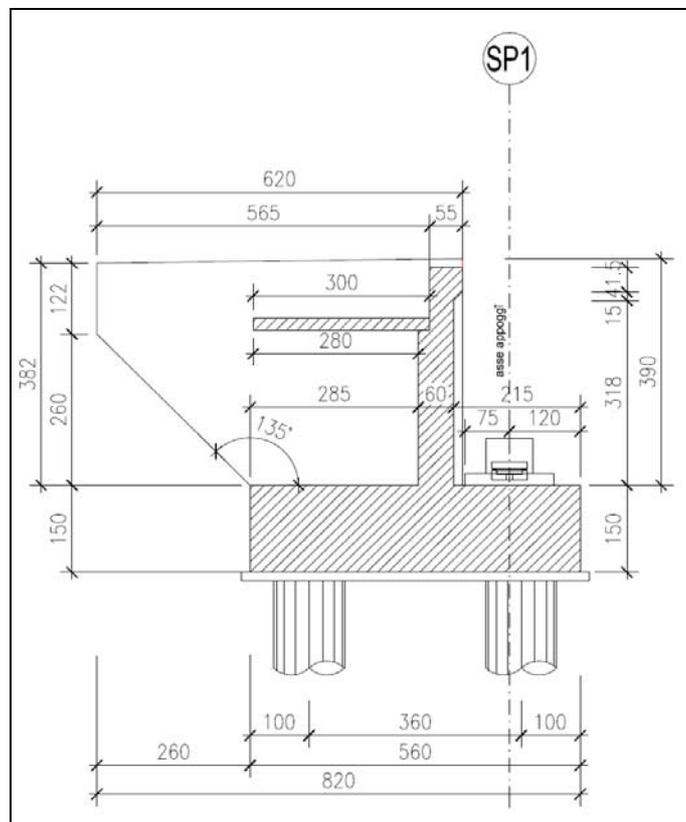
SEZIONE TRASVERSALE SPALLA
